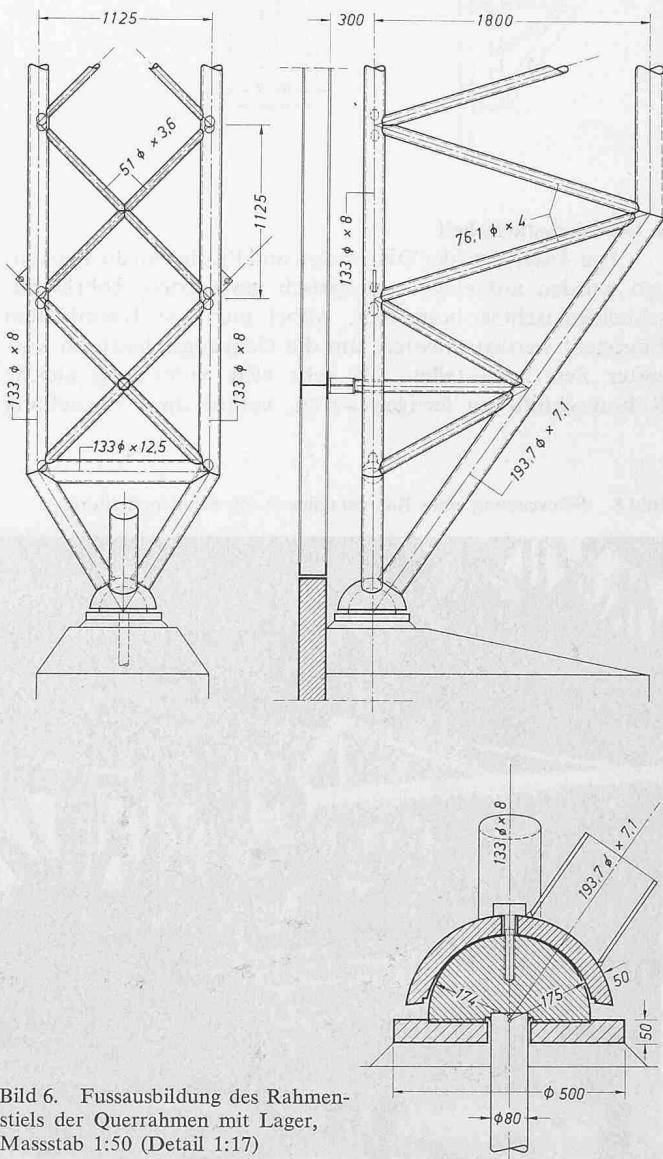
Fussausbildung des Rahmenstiels der Querrahmen mit Lager, Massstab 1:50 (Detail 1:17)
